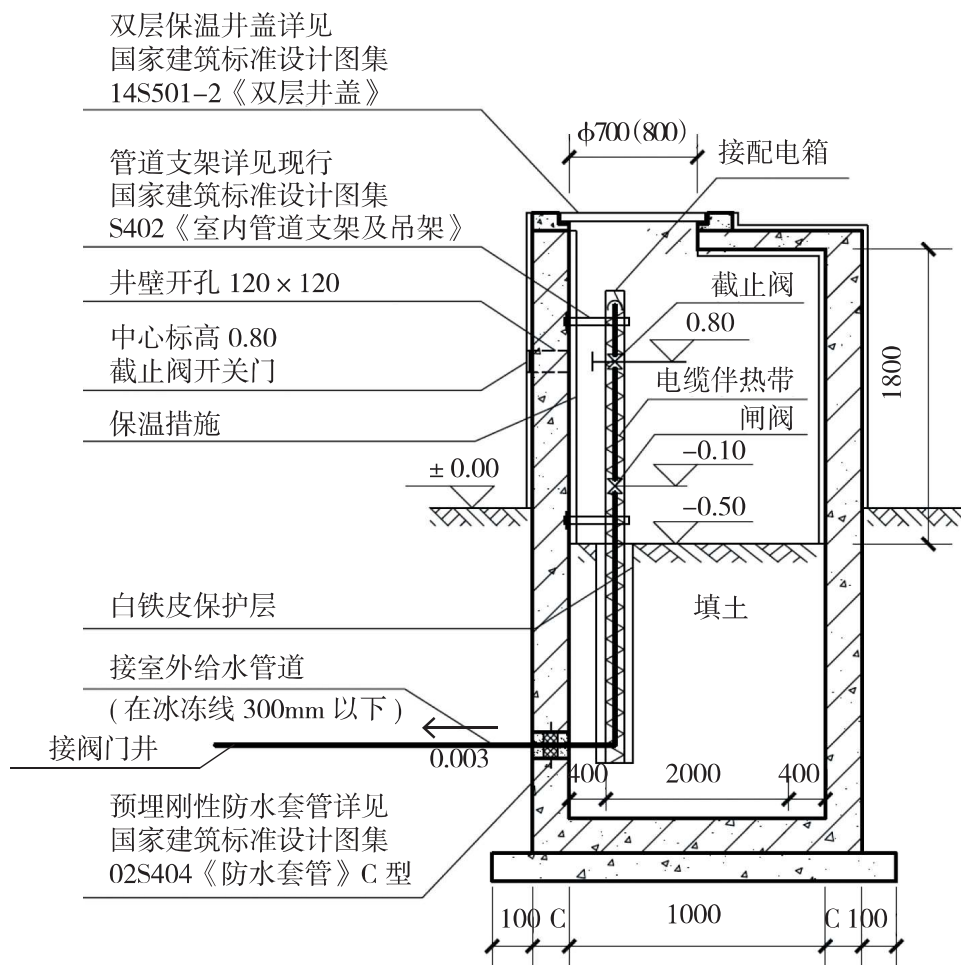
防冻给水栓安装 2-2 剖面示意图
